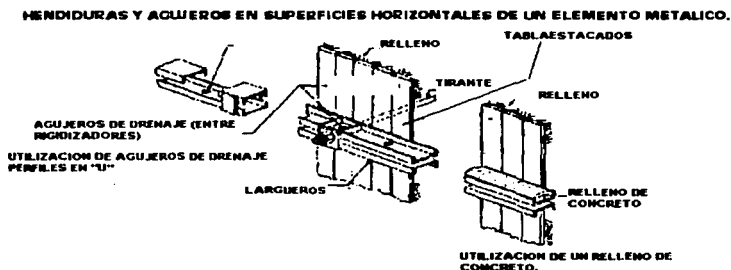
drenaje de perfiles estructurales. El tratamiento de doble T de la ala ancha y normales es análogo.
